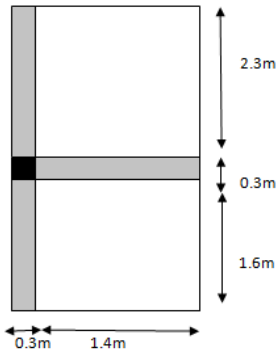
surface afférente poteau p1 accès a la terrasse
